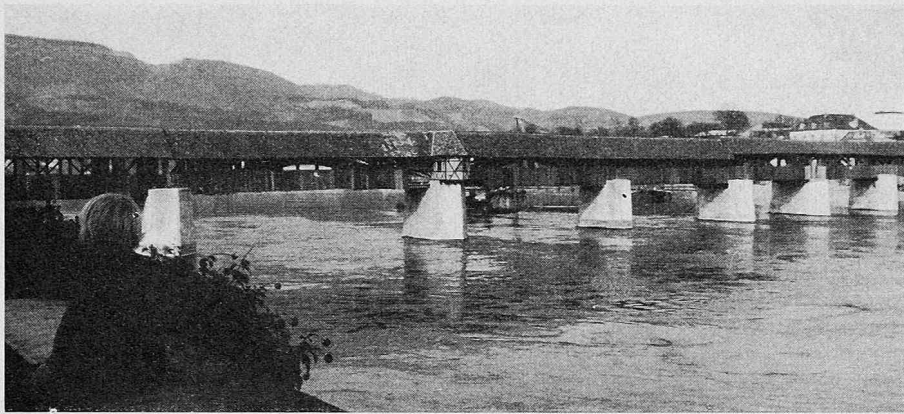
Säckingen: Rheinbrücke. Längste noch bestehende Holzbrücke von gegen 200 m Länge über sieben Öffnungen (max. 32 m Spannweite)
